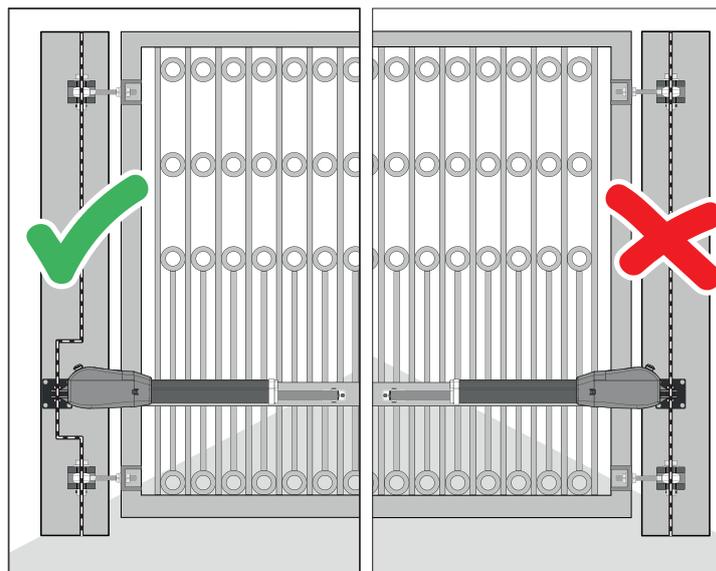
punto di articolazione corretto Fig. 2 punto di articolazione errato
